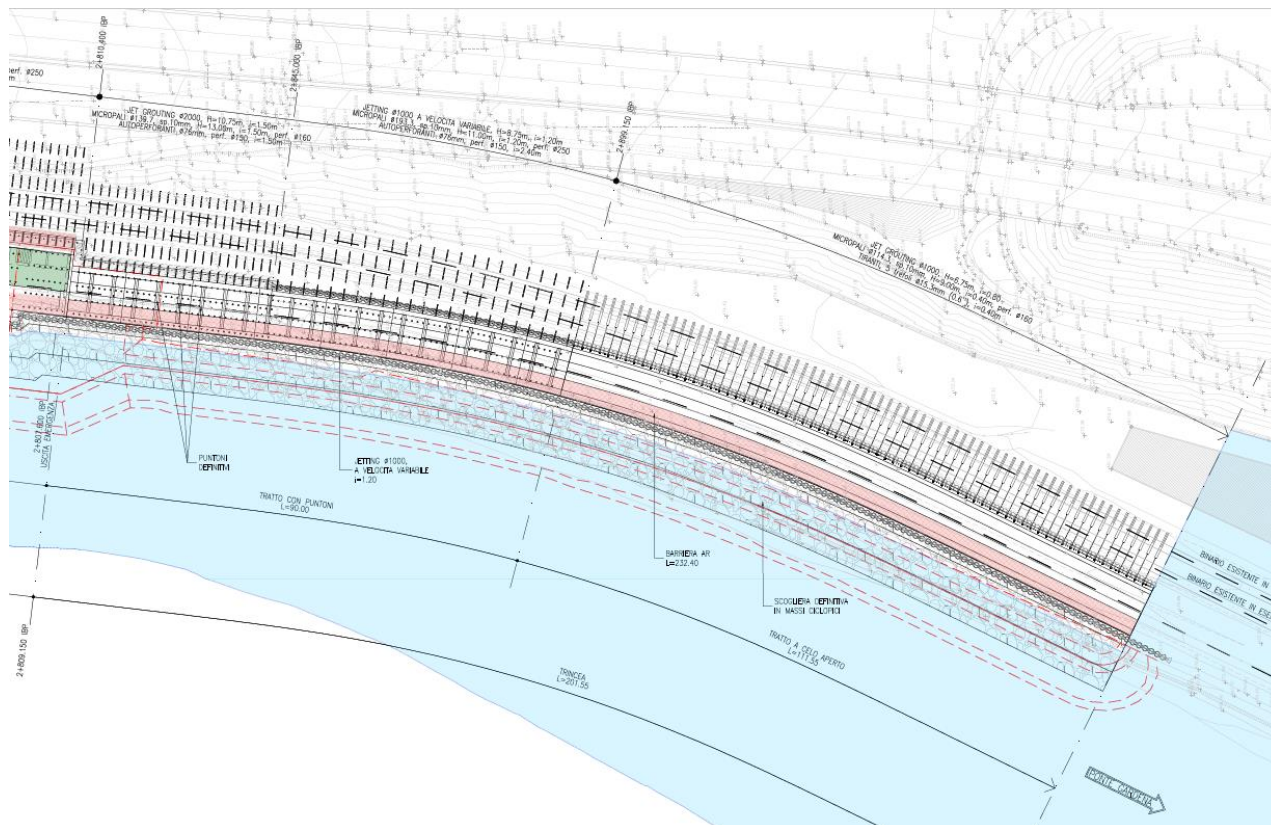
Planimetria dell'imbocco (Parte 1/2)
